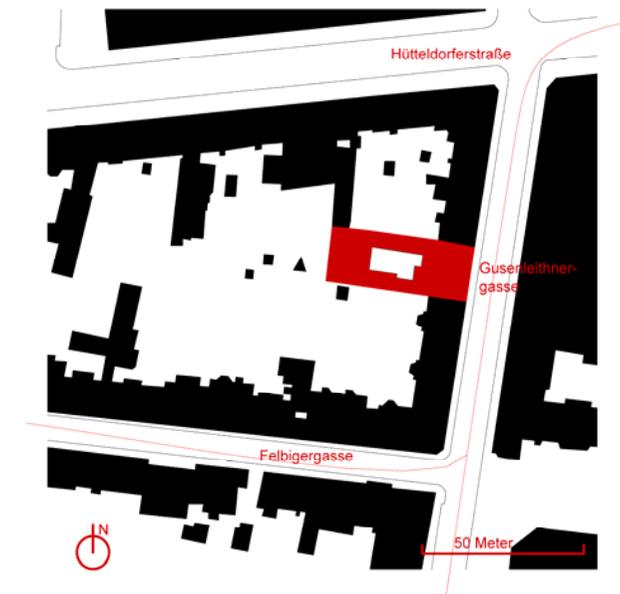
Lageplan Gusenleithnergasse 17 (ROT)
